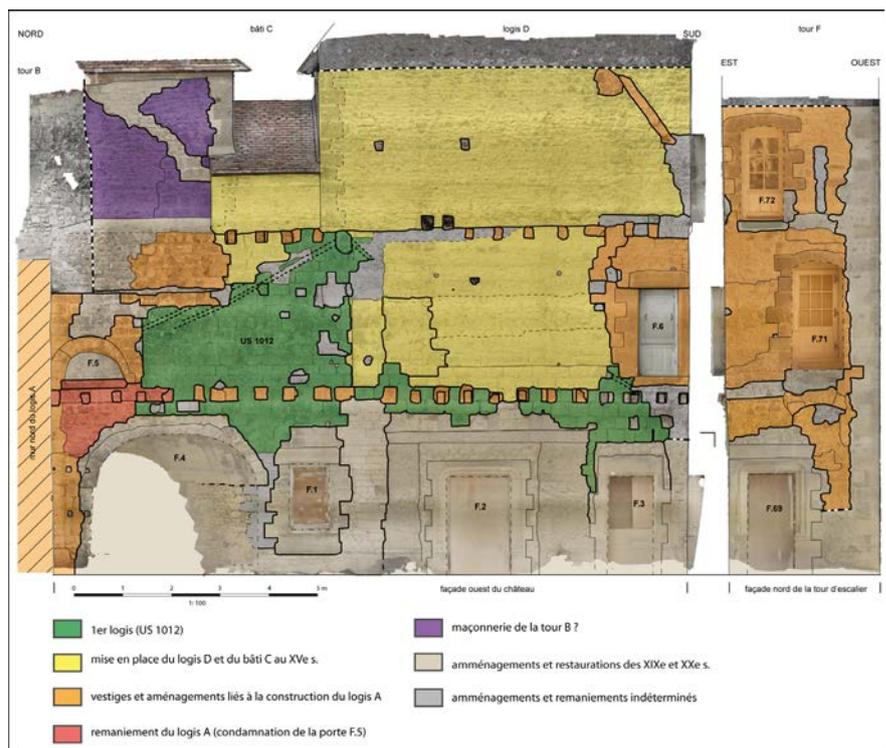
Betz-le-Château (Indre-et-Loire) château : phasage des principaux remaniements identifiés sur la façade ouest et la face nord de la tour d'escalier du château. (Nicolas Holzem, Inrap)
